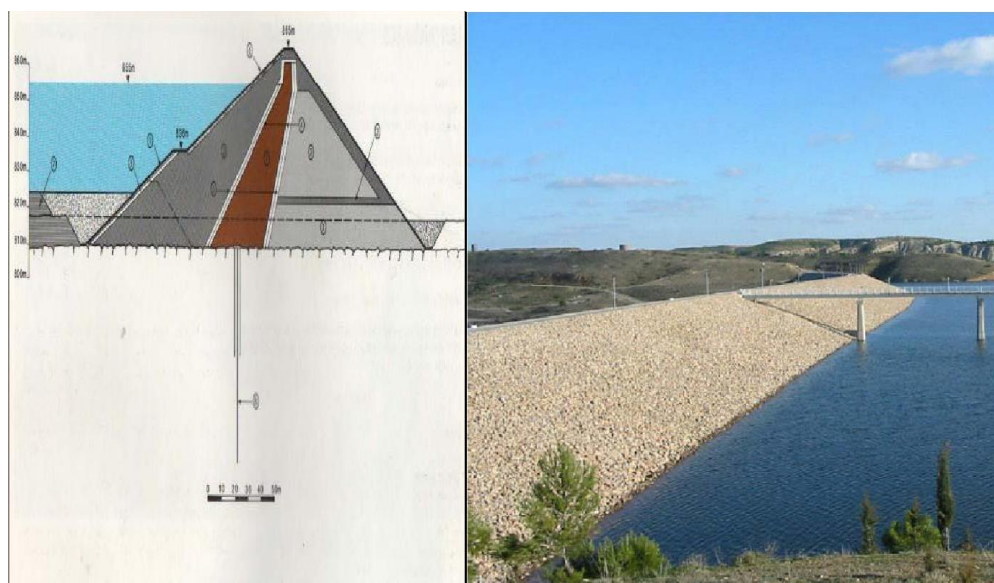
Photo de la digue principale et coupe en travers du barrage d'Ain zada (ANBT).
